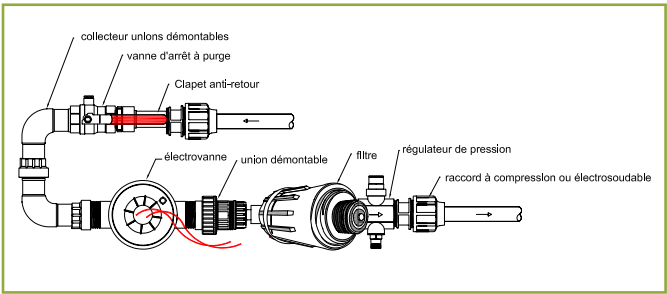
Schéma d'une nourrice voie de goutte-à-goutte – Vue en plan
